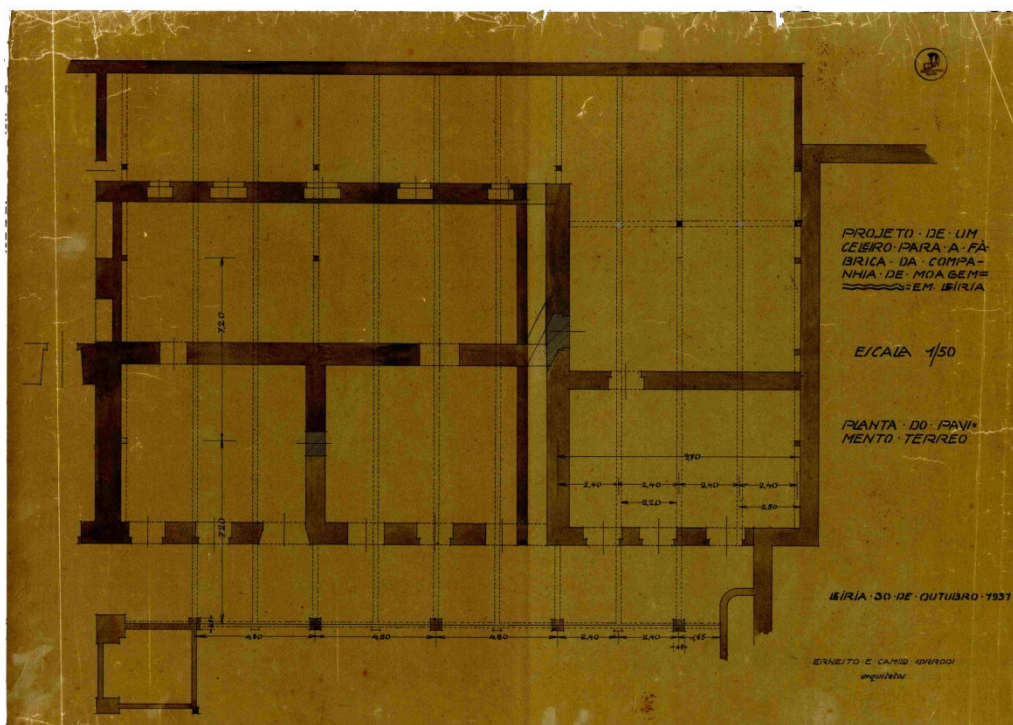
Planta do piso térreo do celeiro construído posteriormente à transformação do convento em moagem
